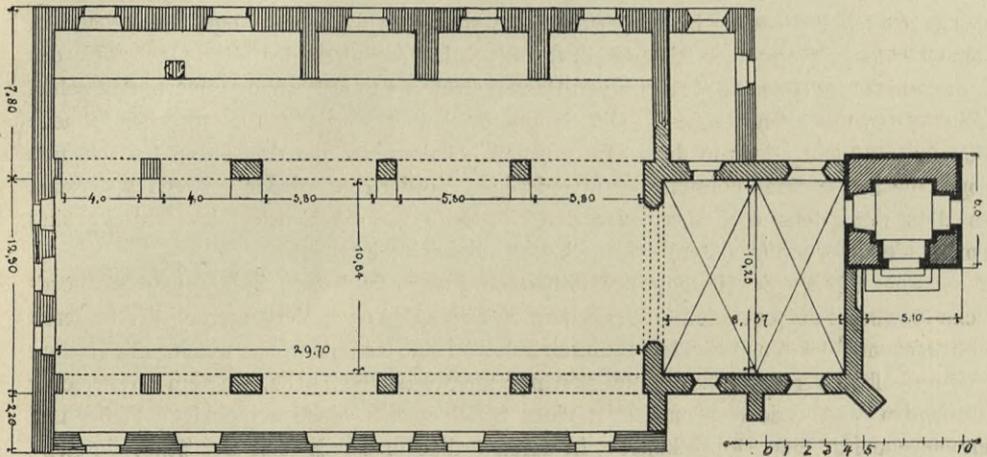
Tauberbischofsheim. Grundriss der Stadtkirche.
